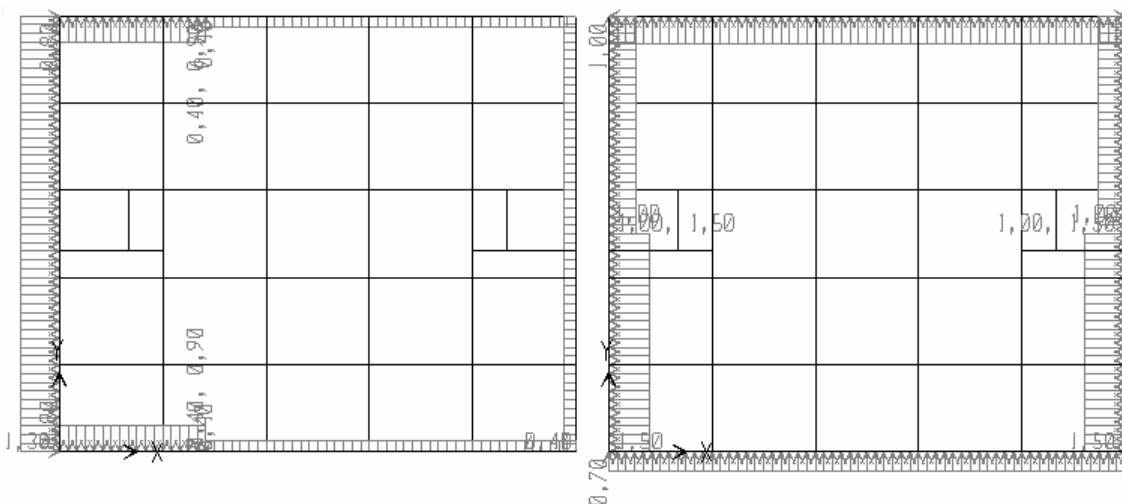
Carregamento de vento no 20º pavimento nas direções x e y.
